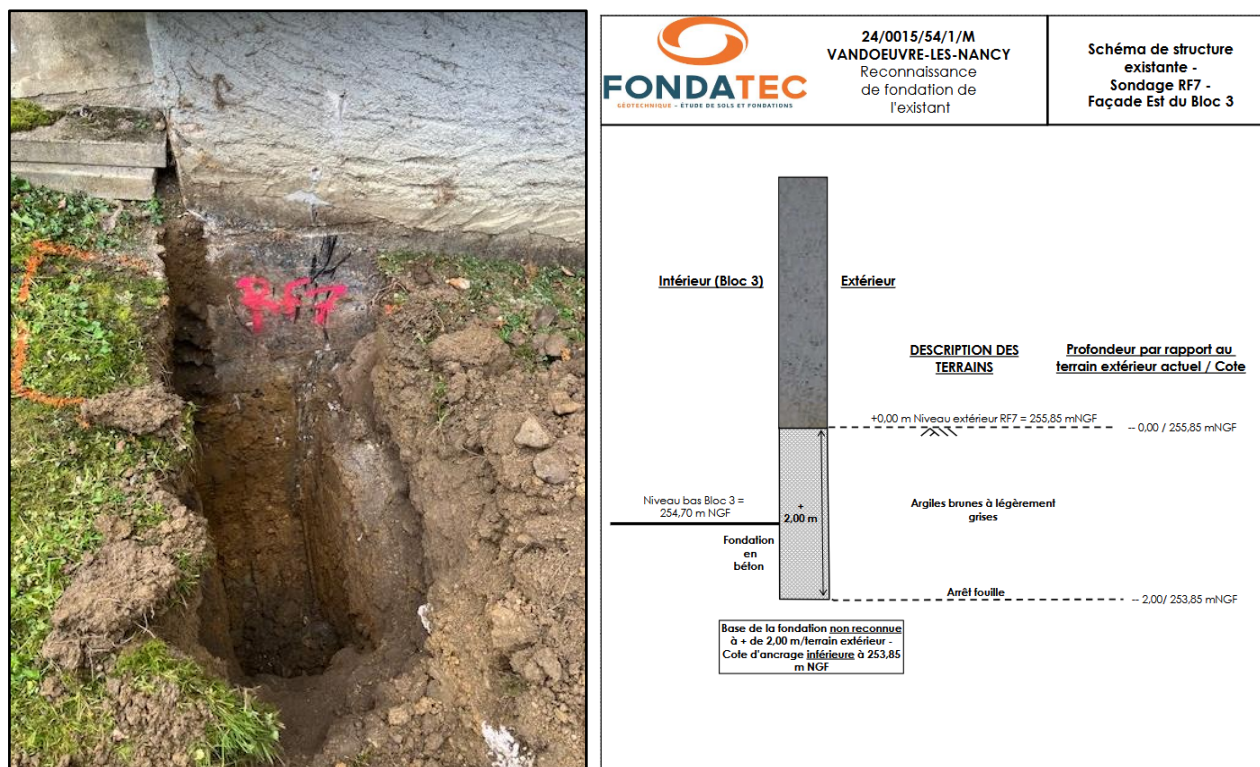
Photographie et coupe de la reconnaissance de fondation RF7 du bloc 3
